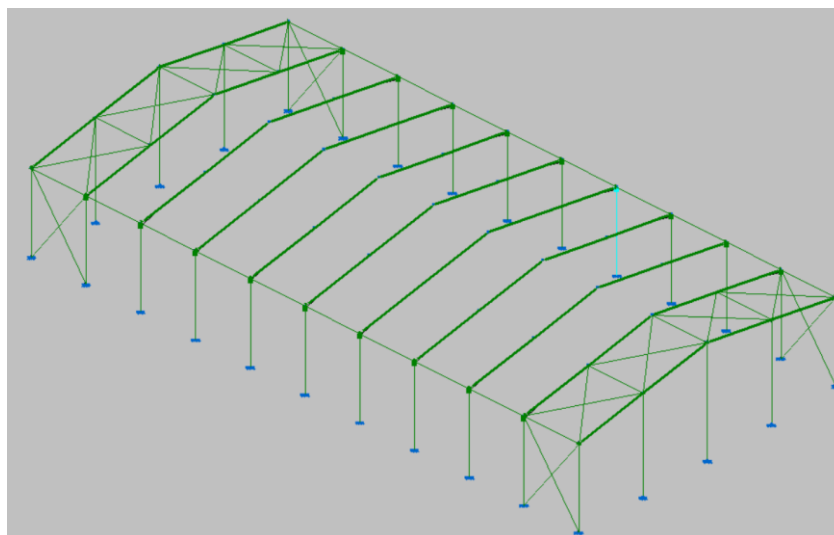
Estructura calculada y con perfiles seleccionados válidos (color verde)
